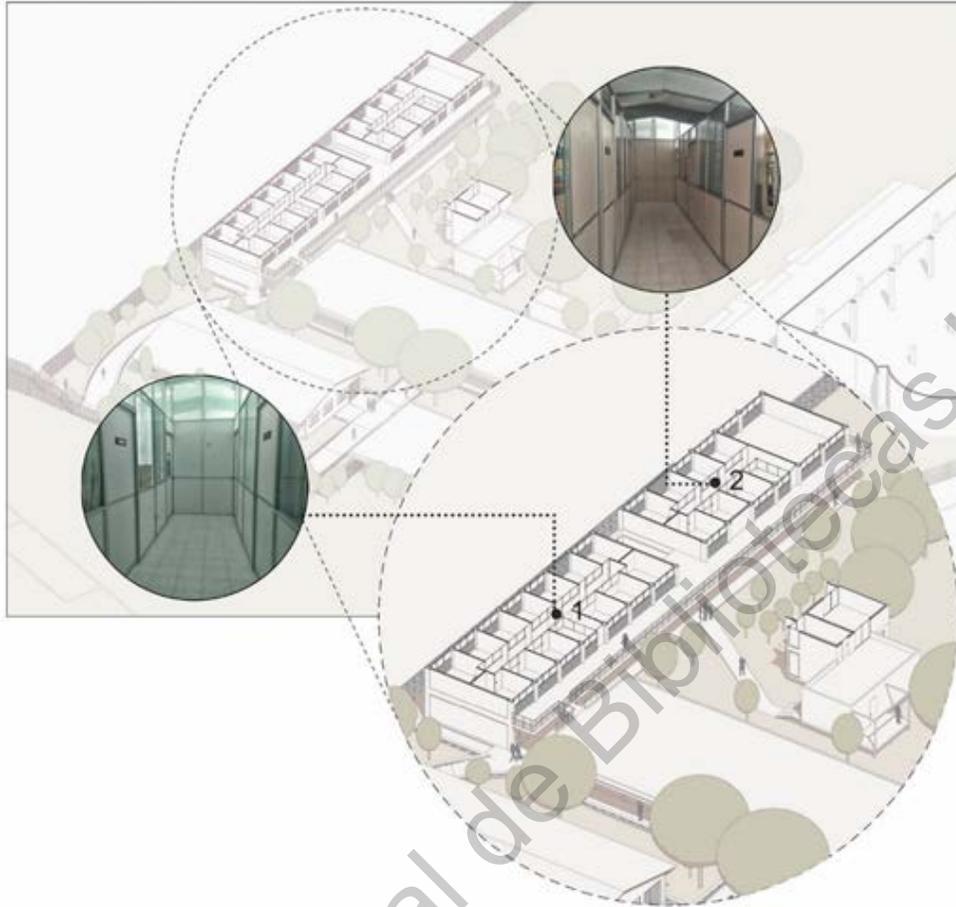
Interior de la planta alta del Edificio F (Elaboración propia).
